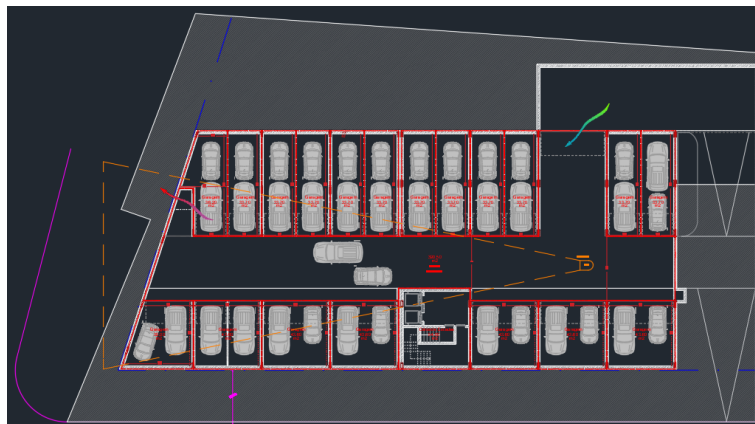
Planta do Piso -2 - Ventilador de Impulso
